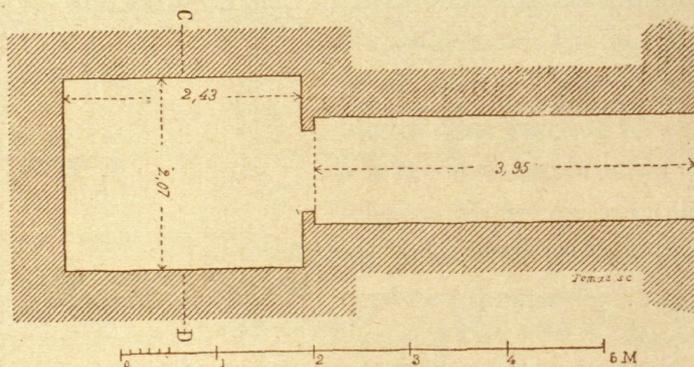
TÚMULUS DE ASSARLIK. - PLANTA, SEGÚN PATON
